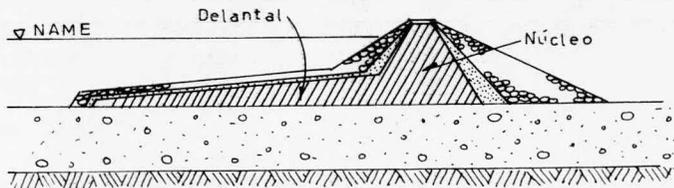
Sección de cortina con delantal impermeable ( $H_c > 20 \text{ m}$ )
